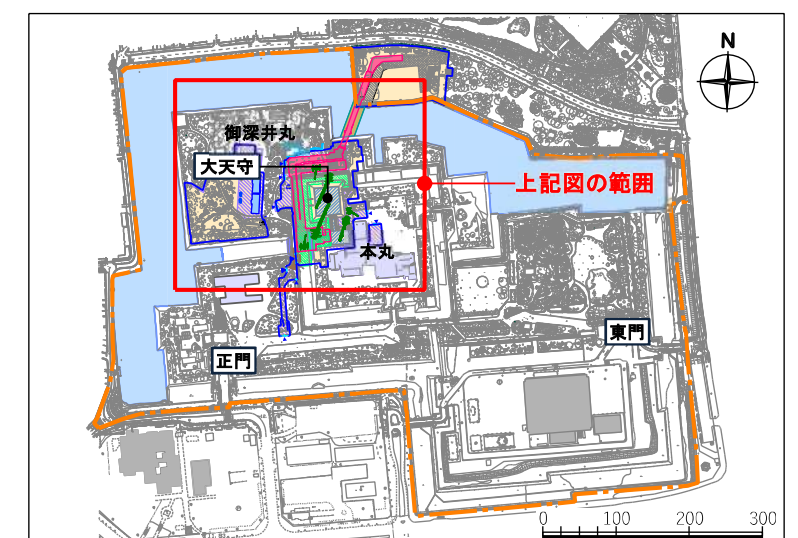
現天守閣解体工事時の平面図(敷地全体)
